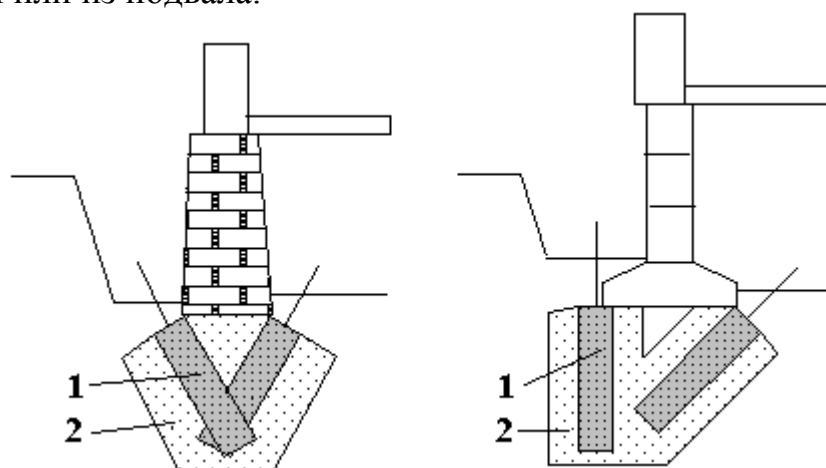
Уплотнение грунта основания под фундаментом выштампованными микросваями: 1 – микросвая; 2 – уплотненный грунт вокруг микросвай
